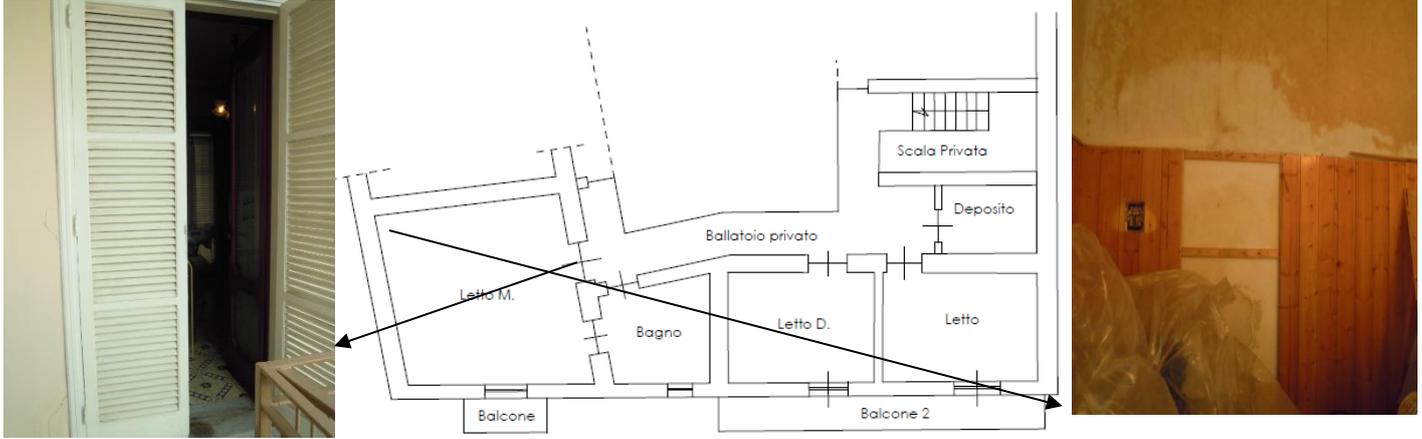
Individuazione fotografica della camera da letto matrimoniale del bene oggetto di pignoramento
